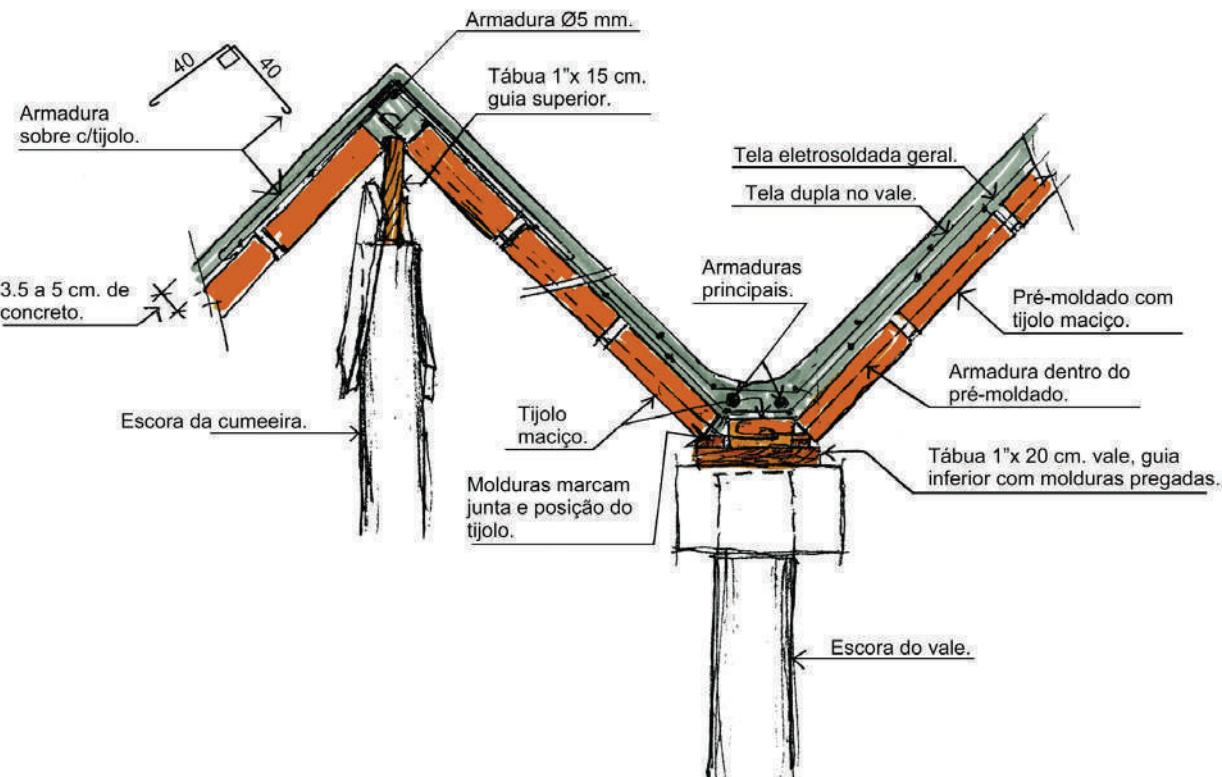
Corte detalhe de uma cobertura plissada. (*-5).
